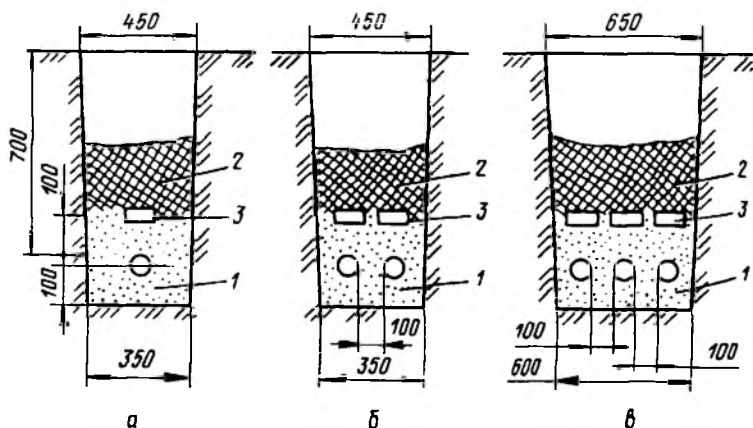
Разрез траншеи для прокладки кабеля напряжением до 10 кВ:
